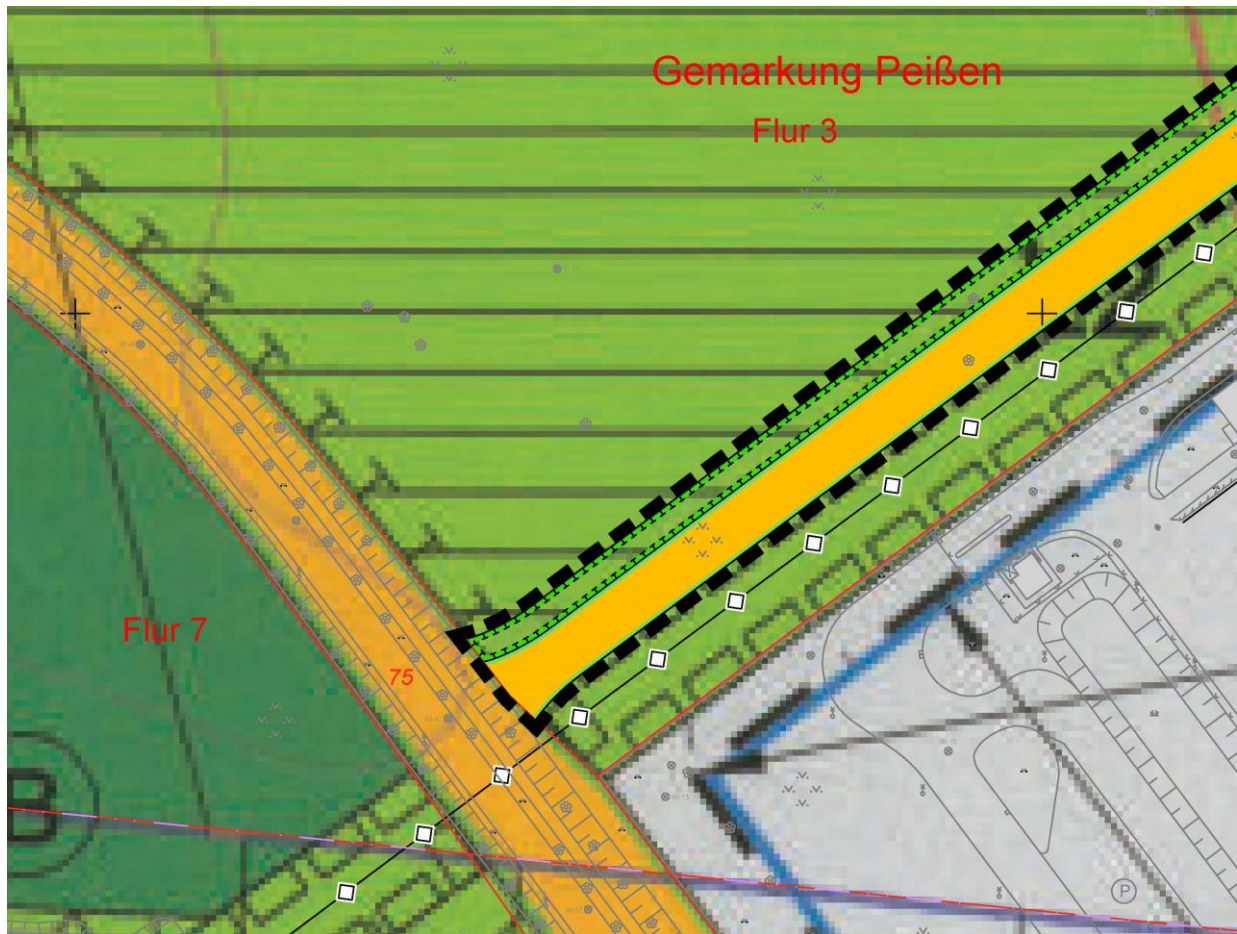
Ausschnitt Überlagerung Bebauungsplan Nr. HS1 mit 3. Änderung
